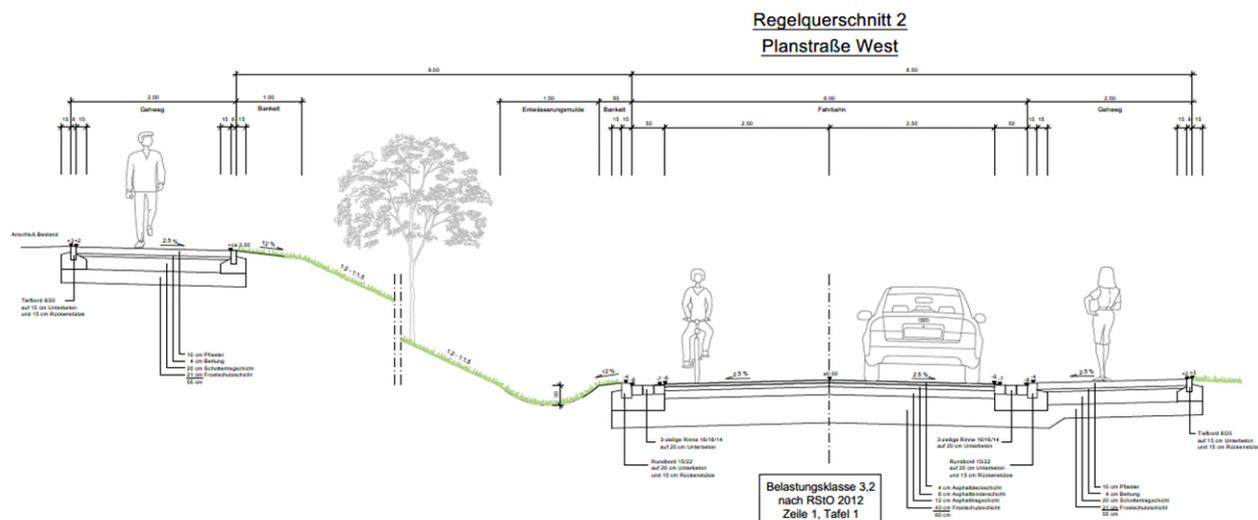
Regelquerschnitt Planstraße West, Darstellung IB Becker
